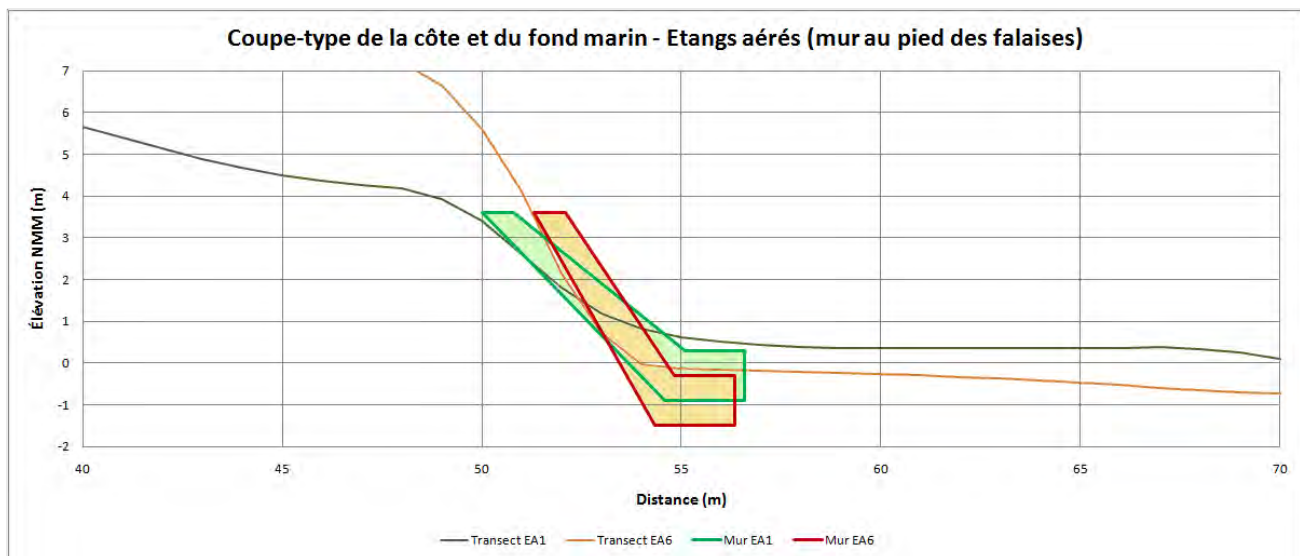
Coupe type d'une protection en béton armé de part et d'autre des étangs aérés
